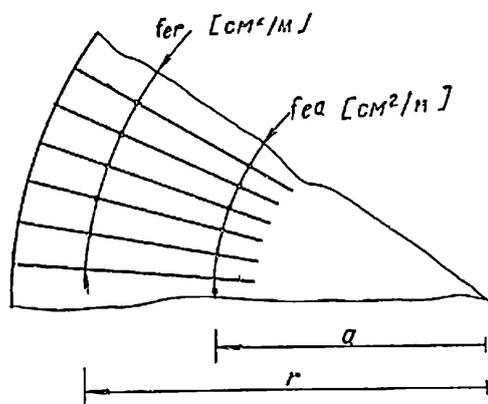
43. Армирование свободно опертых круглых плит тонкими стержнями
